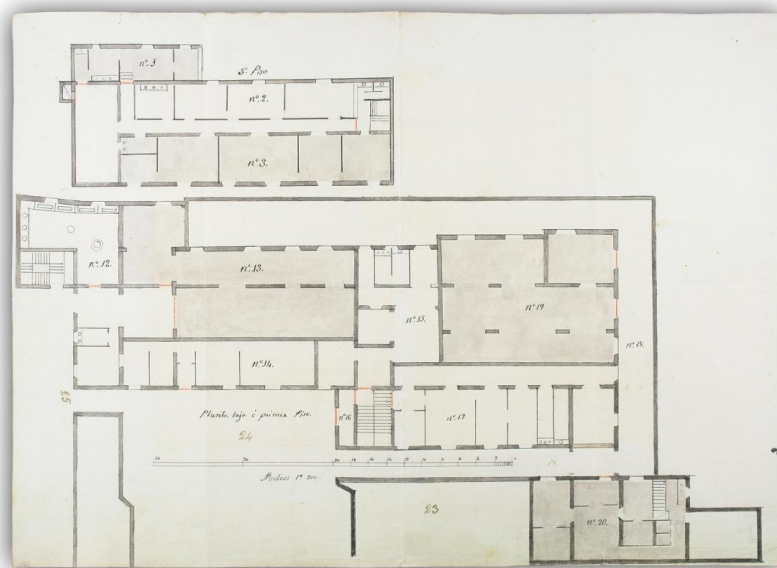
Planta baja y tercer piso del palacio. Propuesta de división en apartamentos.
